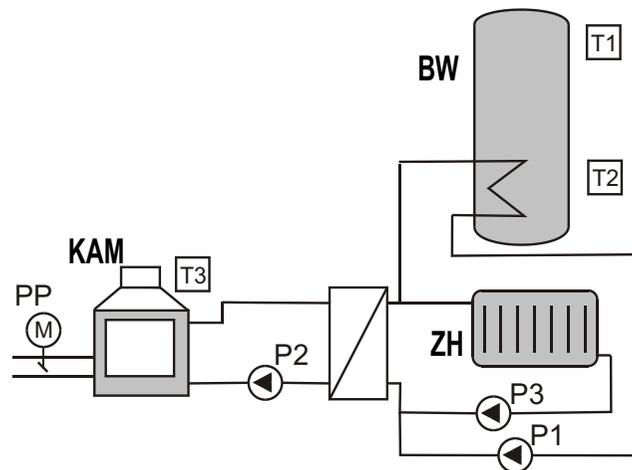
Betriebsschema des Reglers mit Wärmeaustauscher für ZH und BW Schaltung
